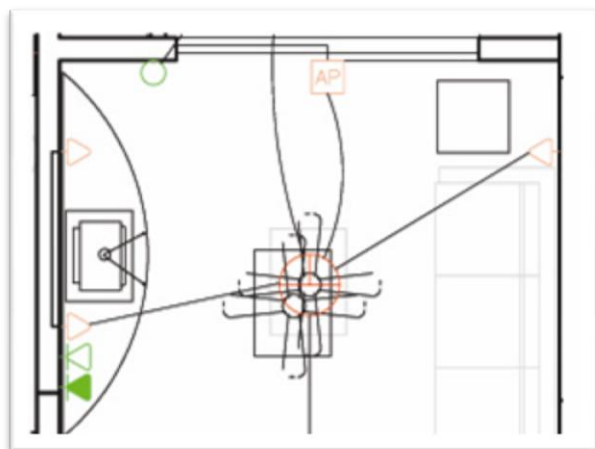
Planta baixa com desalinhamento do ponto de iluminação.
